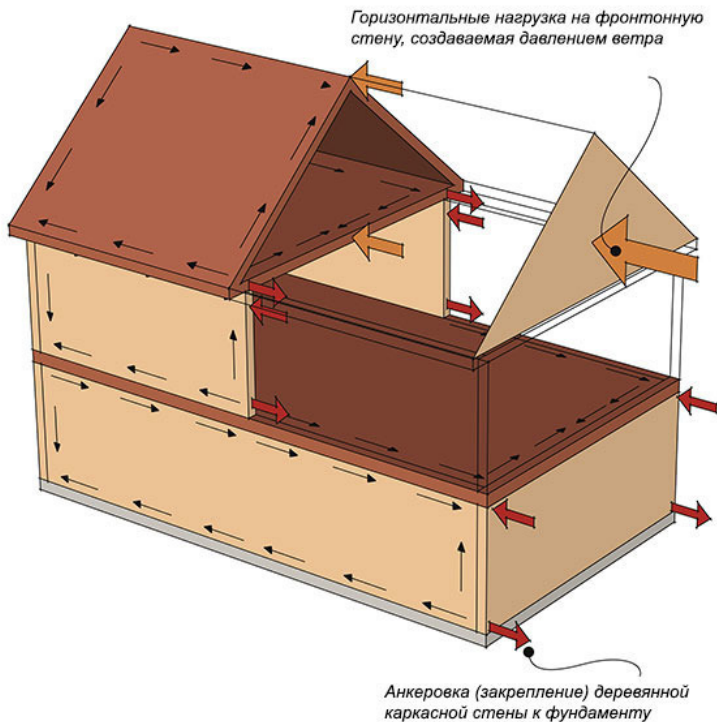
Перераспределение горизонтальной ветровой нагрузки на фундамент с помощью жёсткой обшивки ограждающих конструкций. Стены должны быть обшиты жёсткими плитами как минимум с одной стороны.
